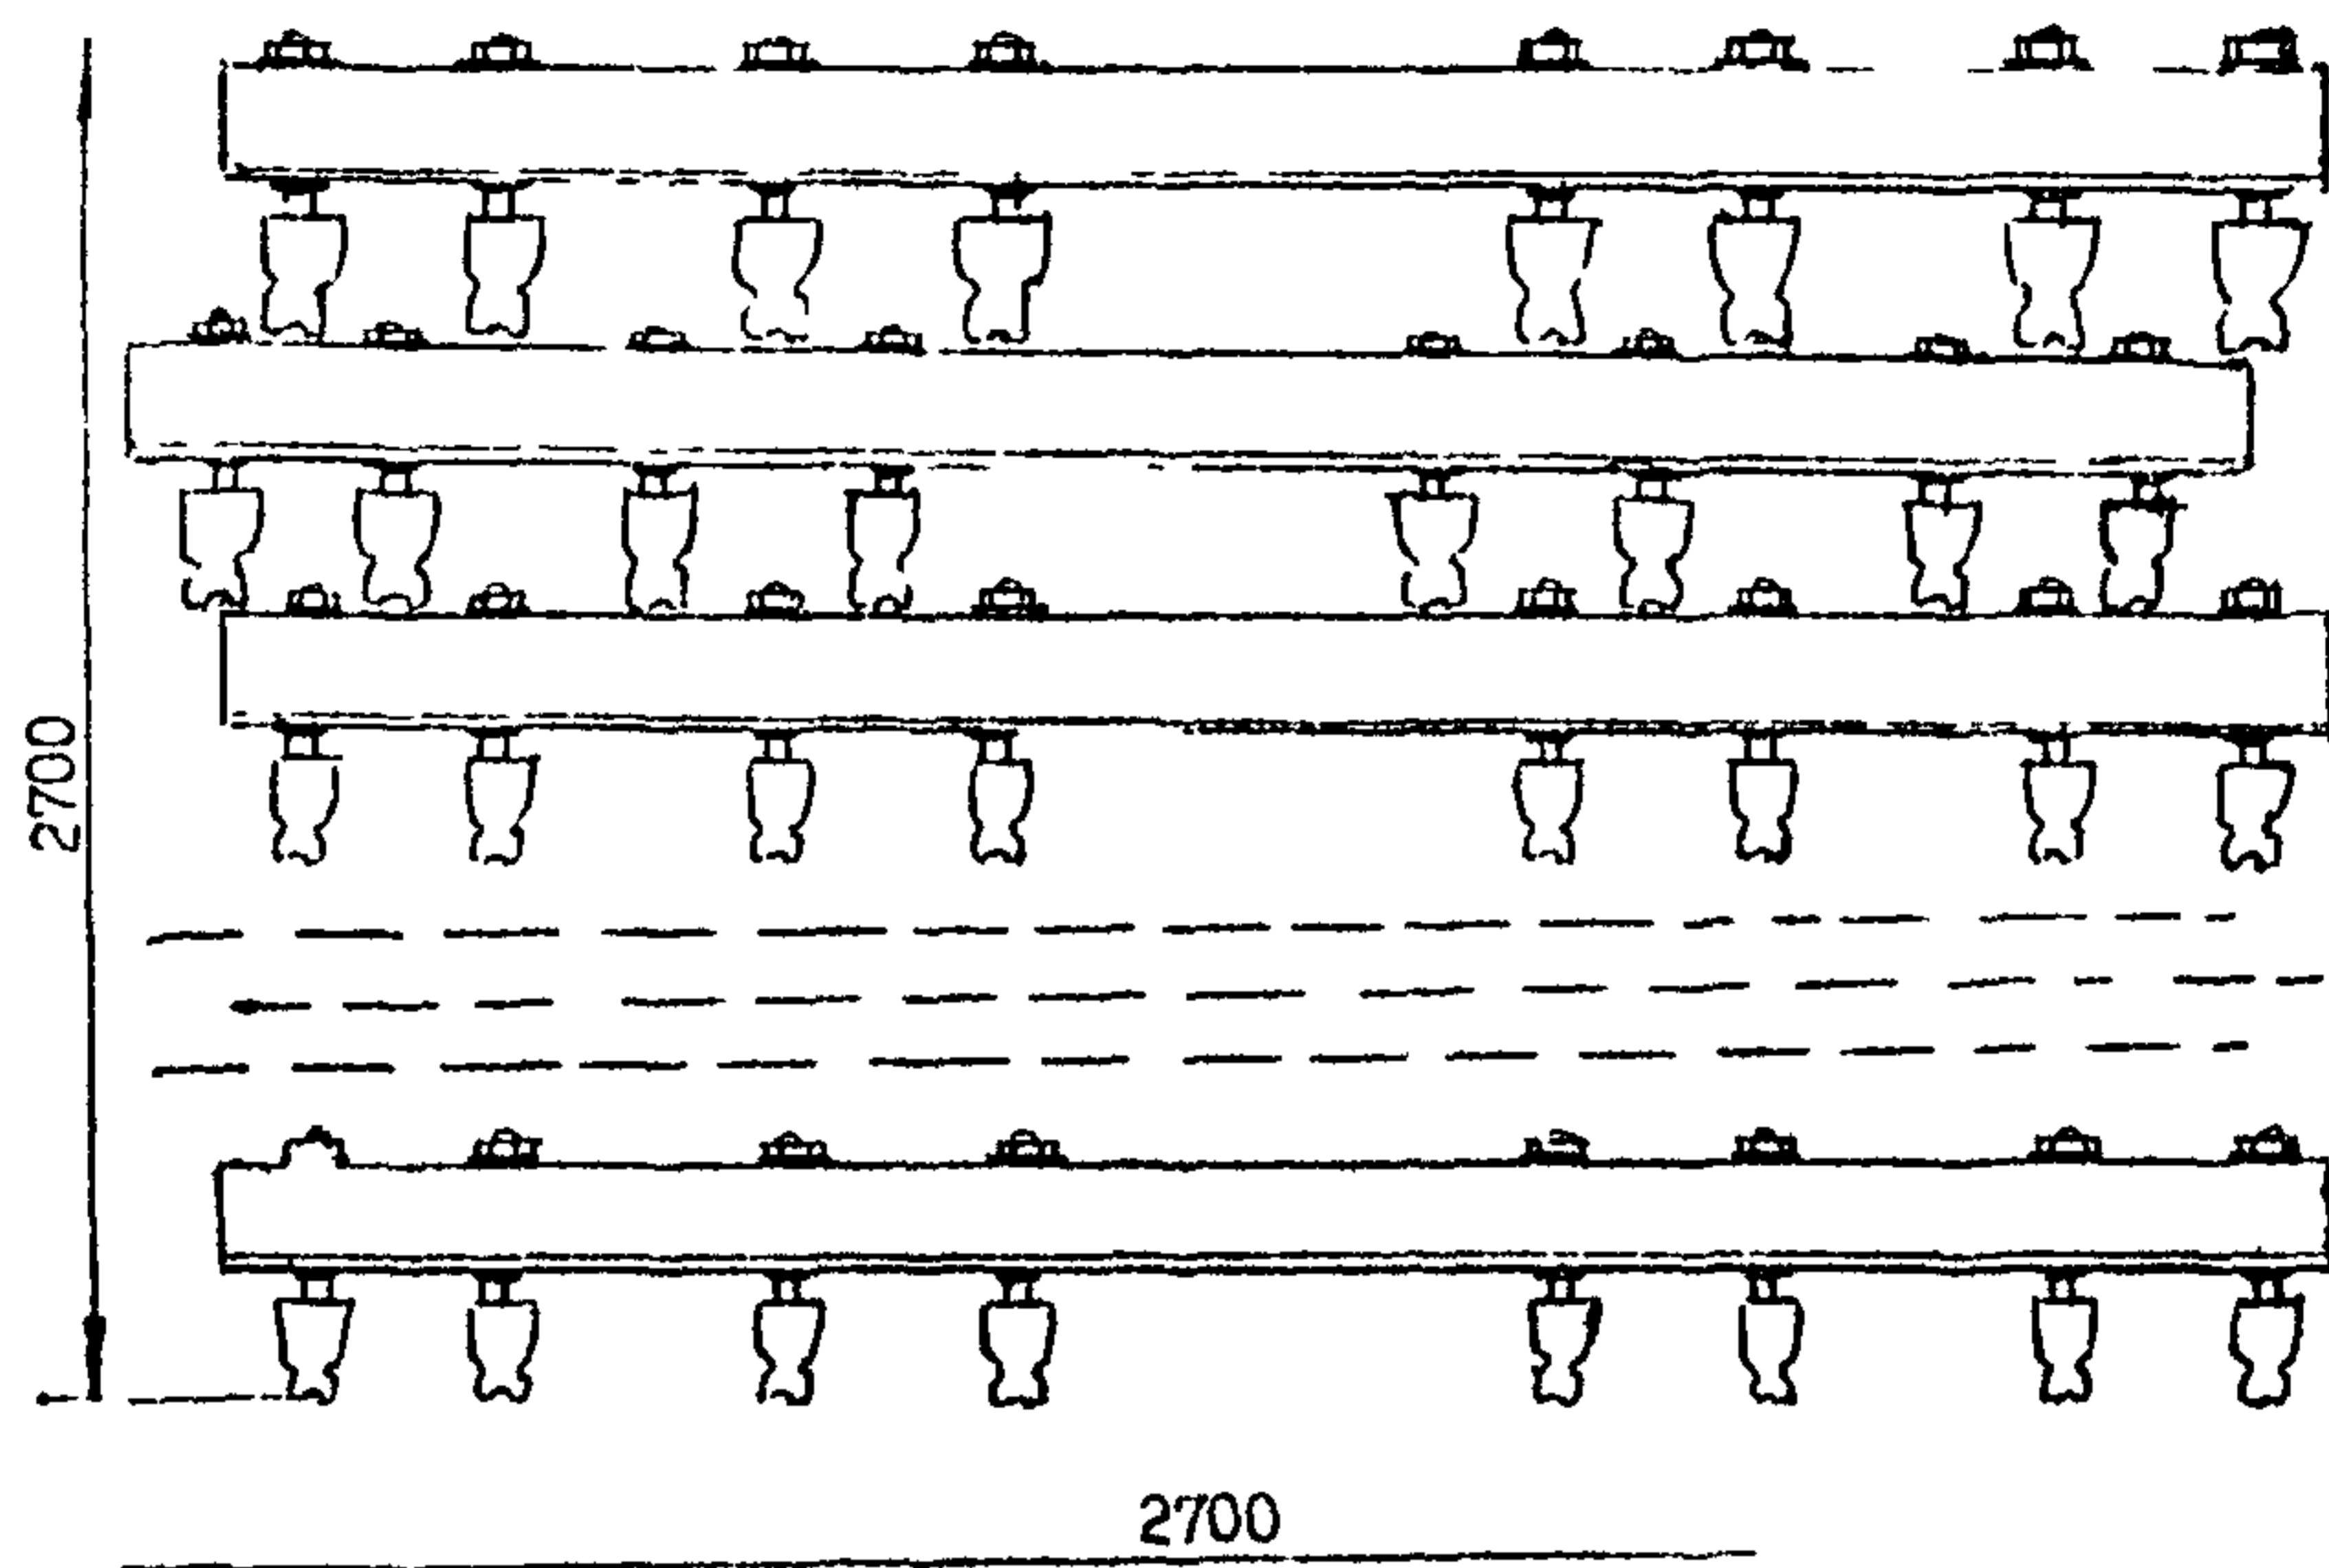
Разгрузка железобетонных стоек у мест установки
